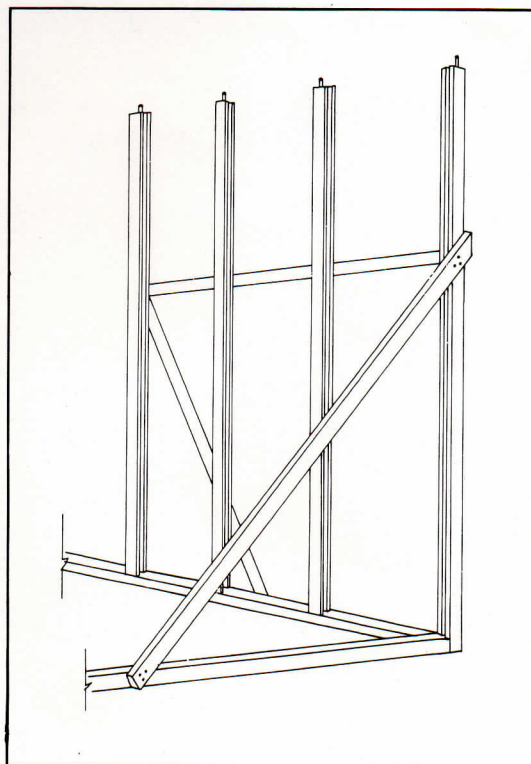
Detalhe da fixação dos pilares em prumo.
